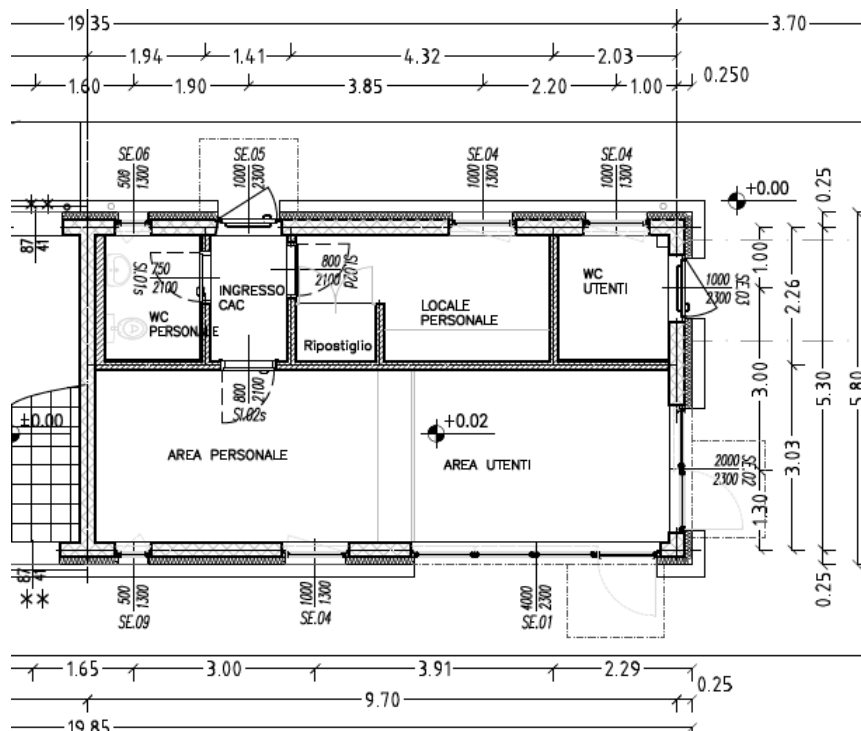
Pianta della porzione di fabbricato destinata a Centro Assistenza Clienti (CAC).
